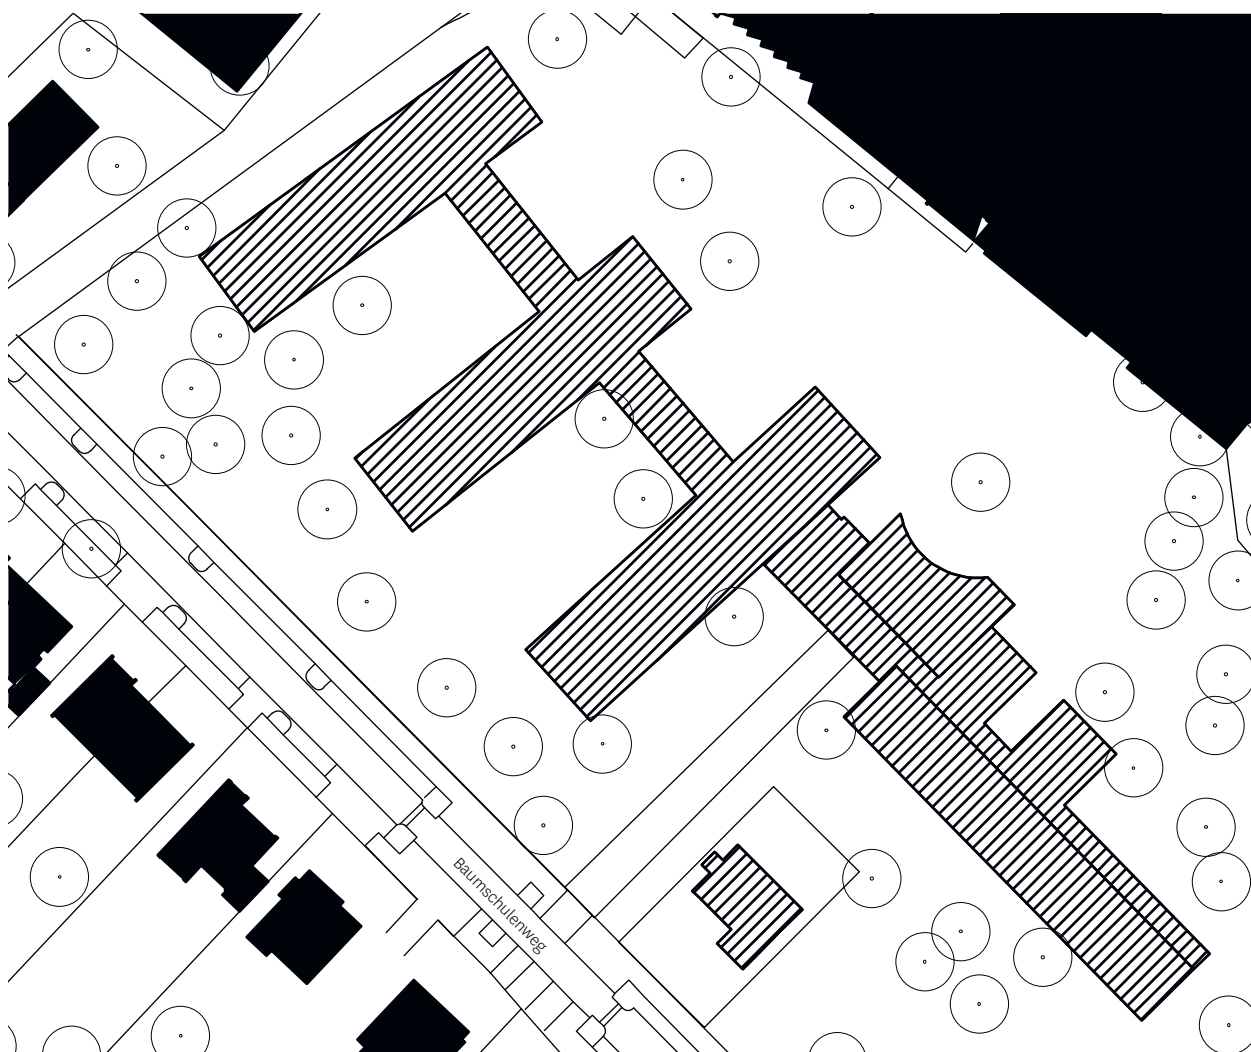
Lageplan genordet – Maßstab 1:1.000
